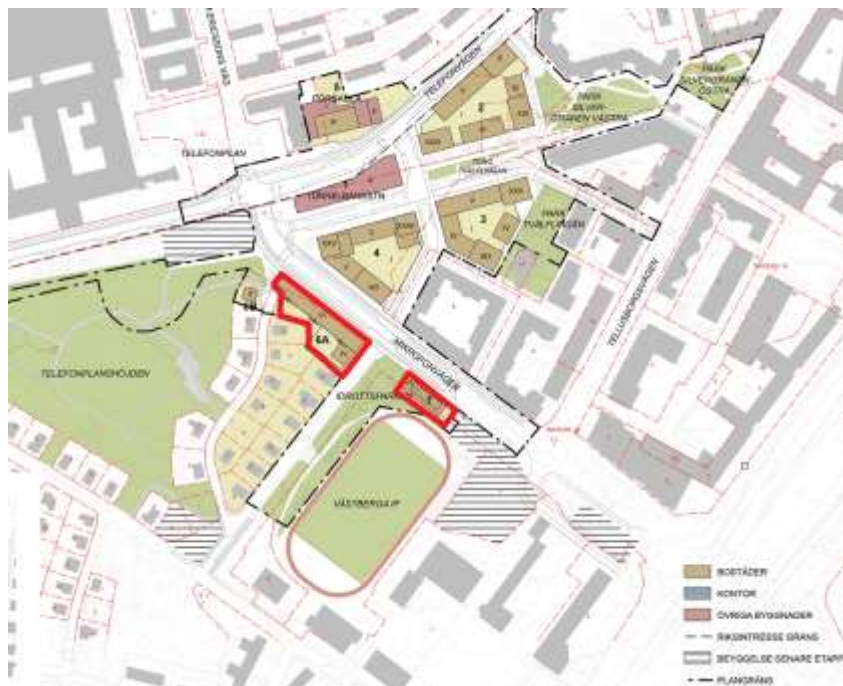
Strukturplan för nu föreslagen etapp och detaljplan i Centrala Telefonplan. Kvarter 6A och 7 föreslås mark anvisas i och med detta beslut, markerade i rött. Skrafferade kvarter kommer markanvisas i senare etapper inom projektet.
